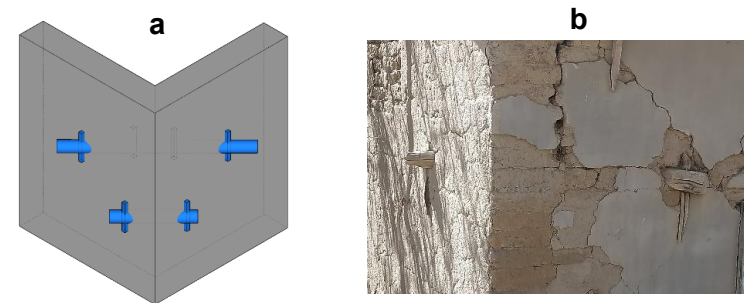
a) Esquema dispositivo DE; b) Fotografía dispositivo DE. Fuente: Archivo y elaboración propia.
